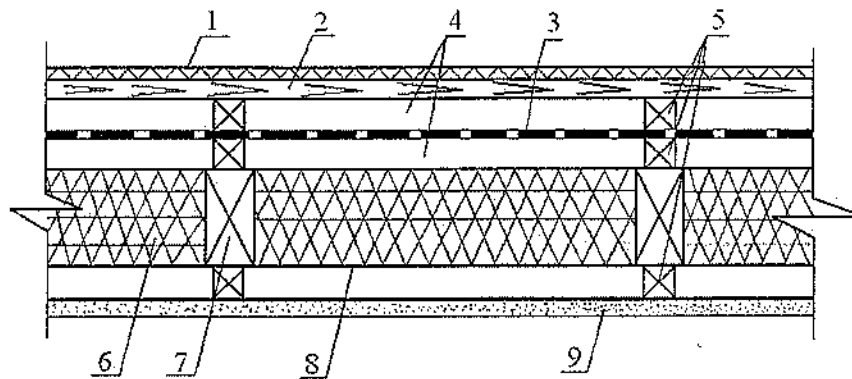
Технические решения конструкции покрытия скатных крыш (над мансардным этажом) с одним (а) и двумя воздушными зазорами над утеплителем.
